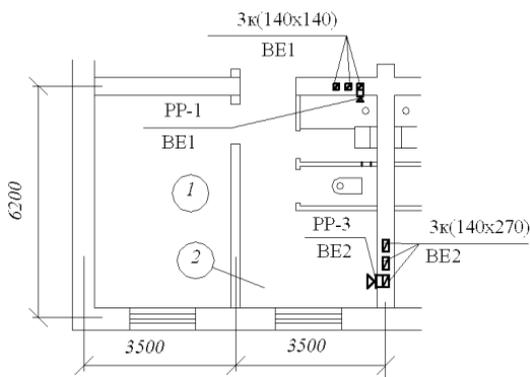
План однокомнатной квартиры на третьем этаже с размещением систем вентиляции
